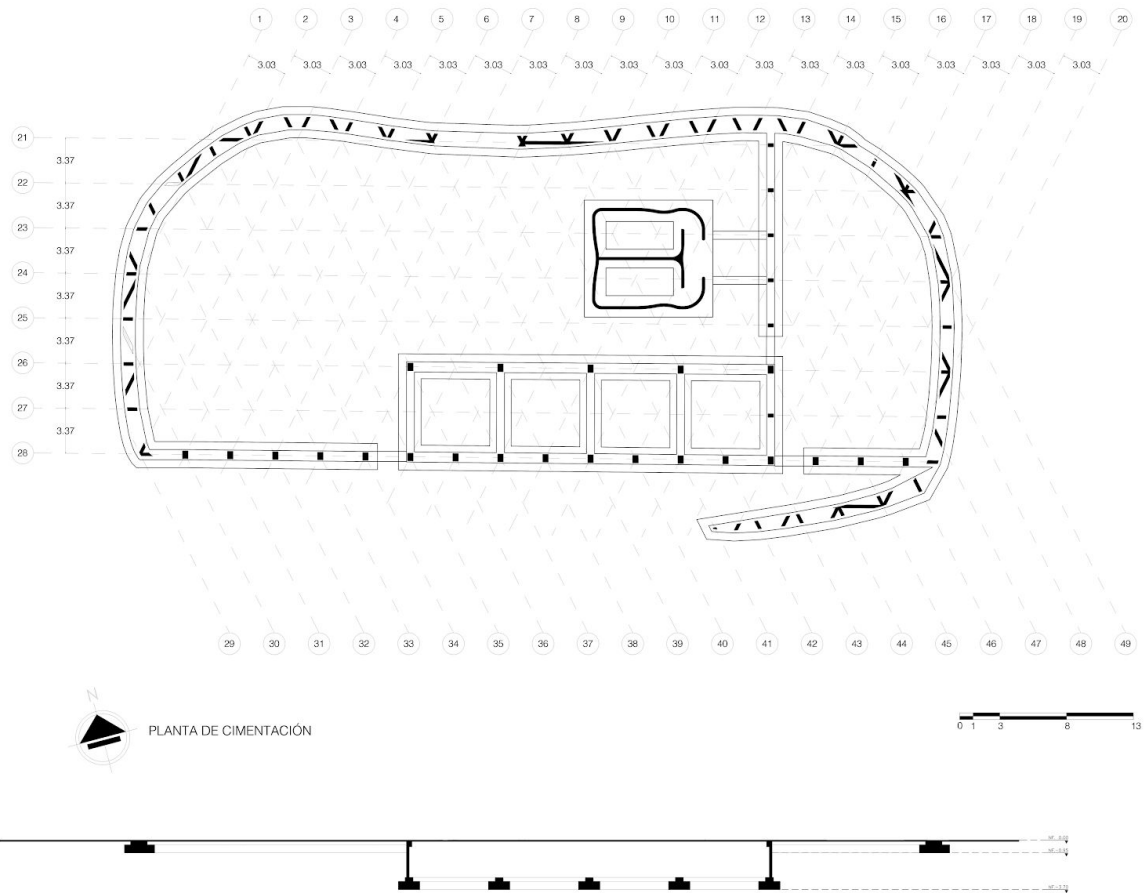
Plano estructural de cimentación y corte esquemático de la profundidad en la que están dispuestos los elementos de cimentación. Elaboración propia
